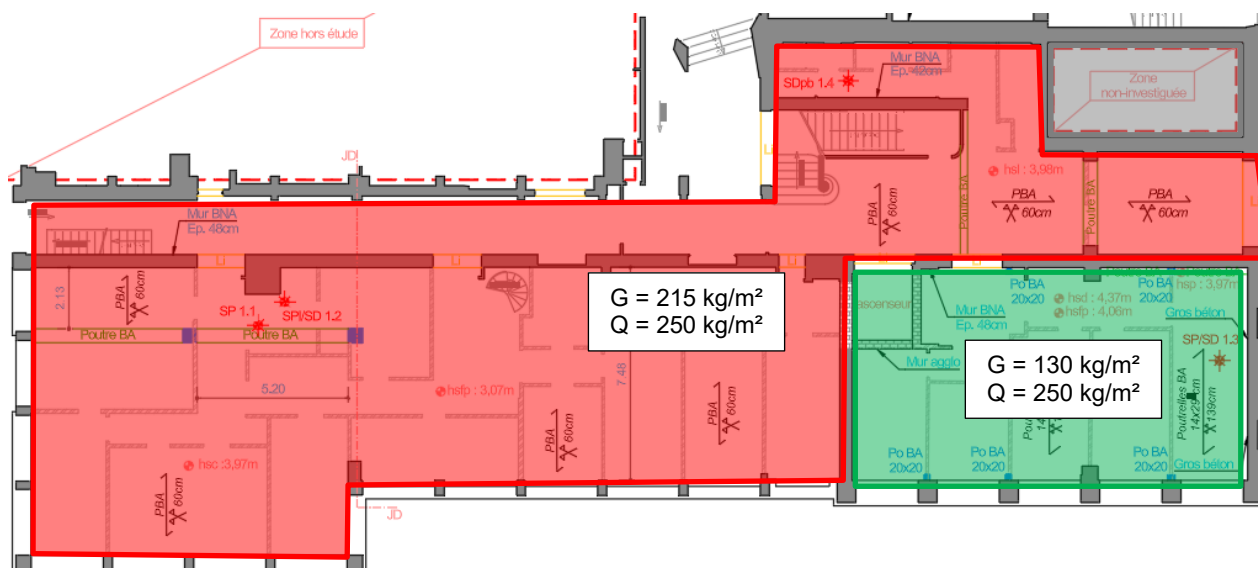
Charges considérées PH RDC (hors poids propre béton armé)
